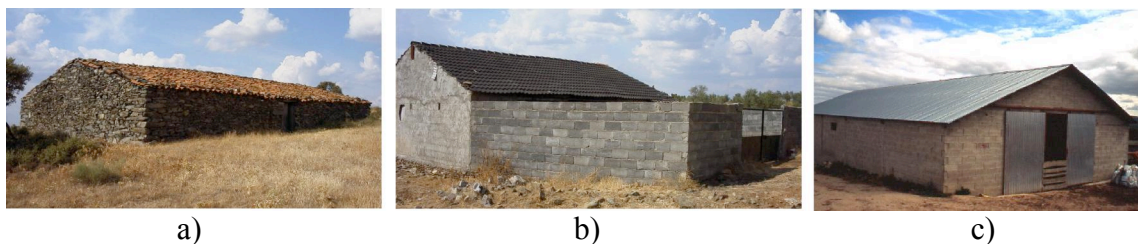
Exemplos de relação entre a idade do edifício e materiais de construção nas paredes e cobertura: pedra de xisto e telha de barro (a), bloco de betão e telha de betão (b), blocos de betão e cobertura de painéis metálicos com isolante térmico (c).
